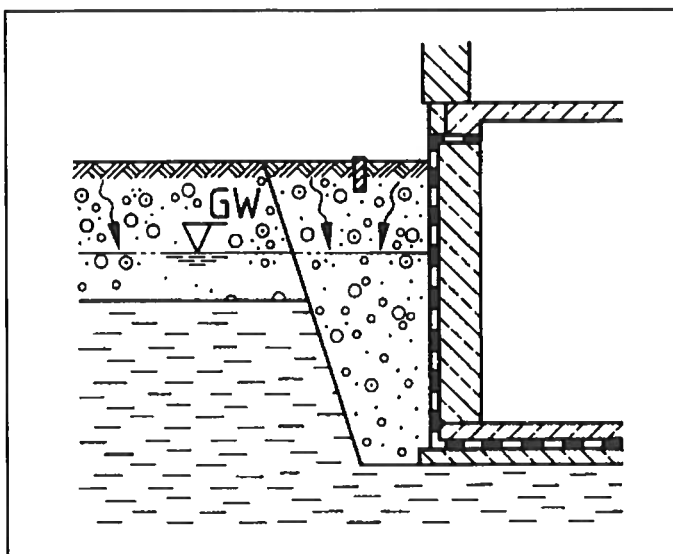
Bauwerksabdichtung nach DIN 18195 T 6
